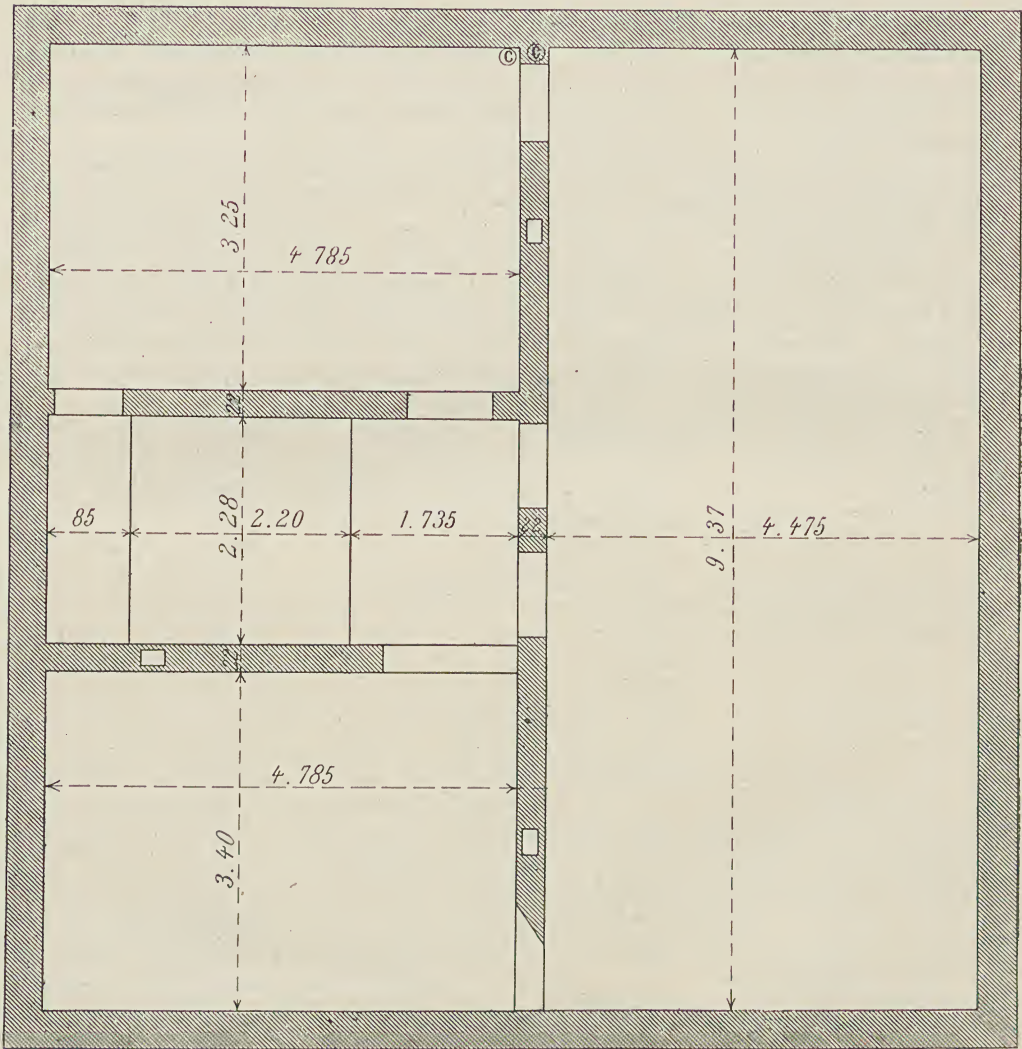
Plan du plancher haut du rez-de-chaussée.
